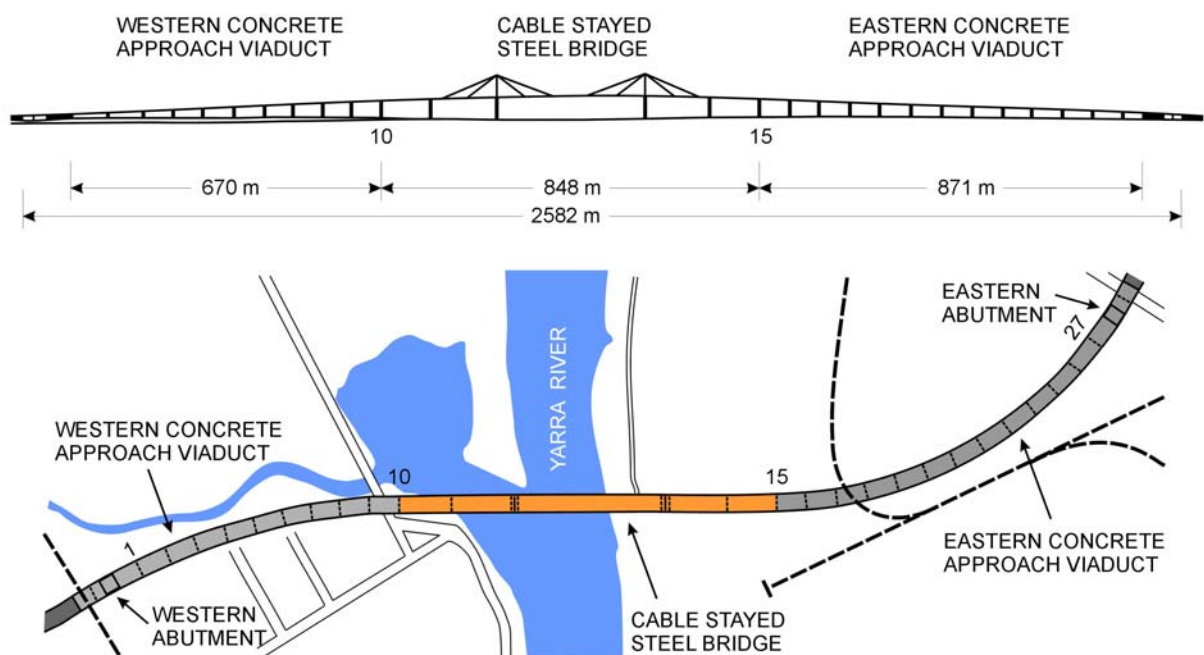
Längsansicht und Lageplan der West Gate Bridge
